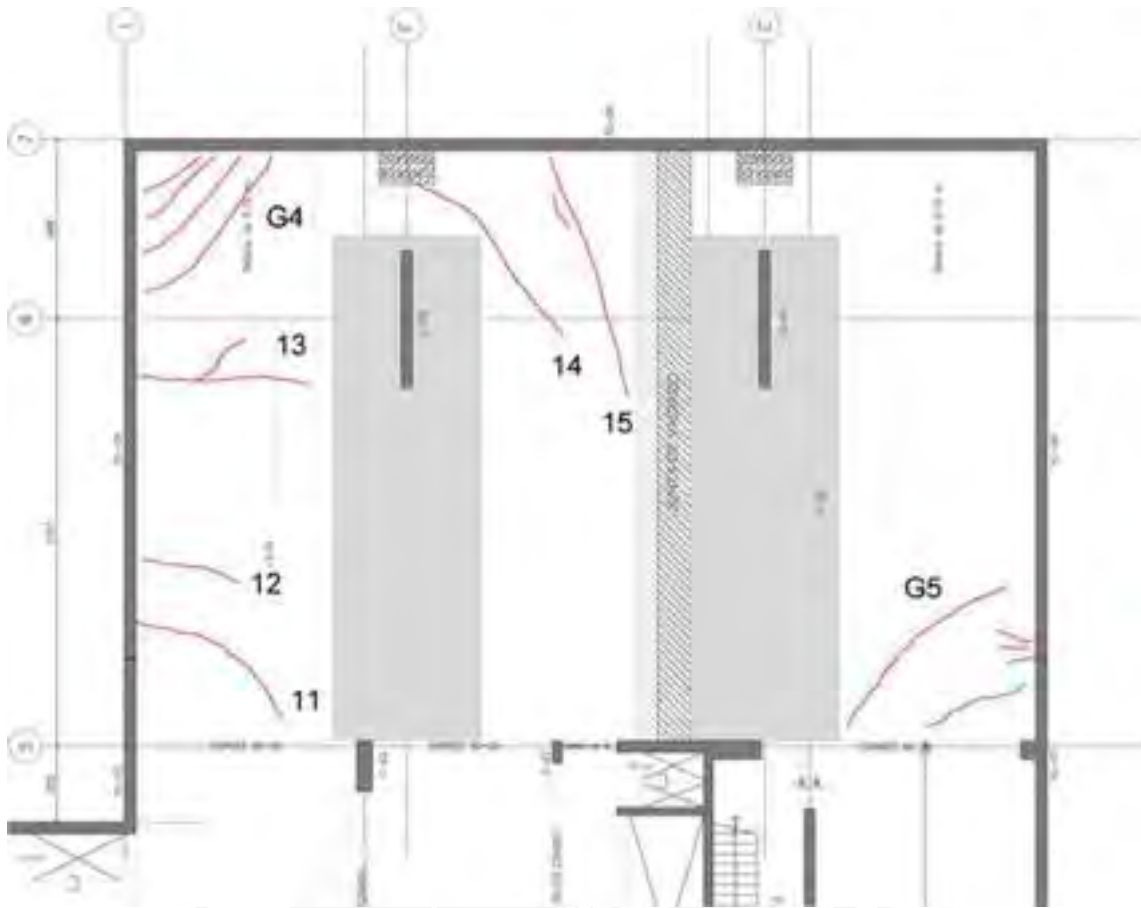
Ubicación de fisuras en semisótano 4
